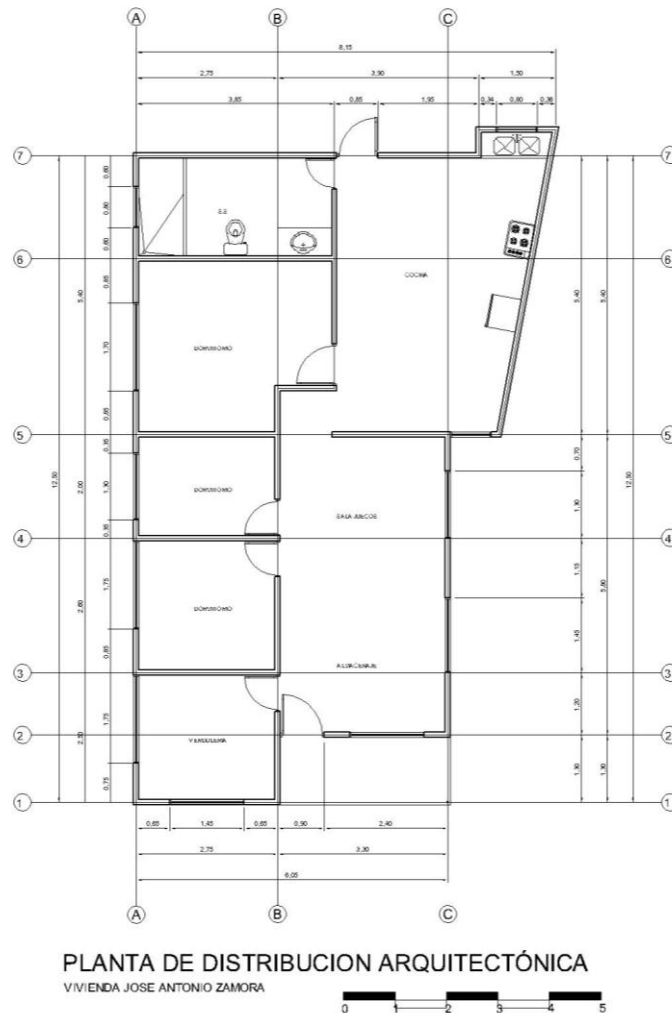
Vivienda José Antonio Zamora. Planta Distribución. Moravia, San José. 2008 Fuente: Personal.
